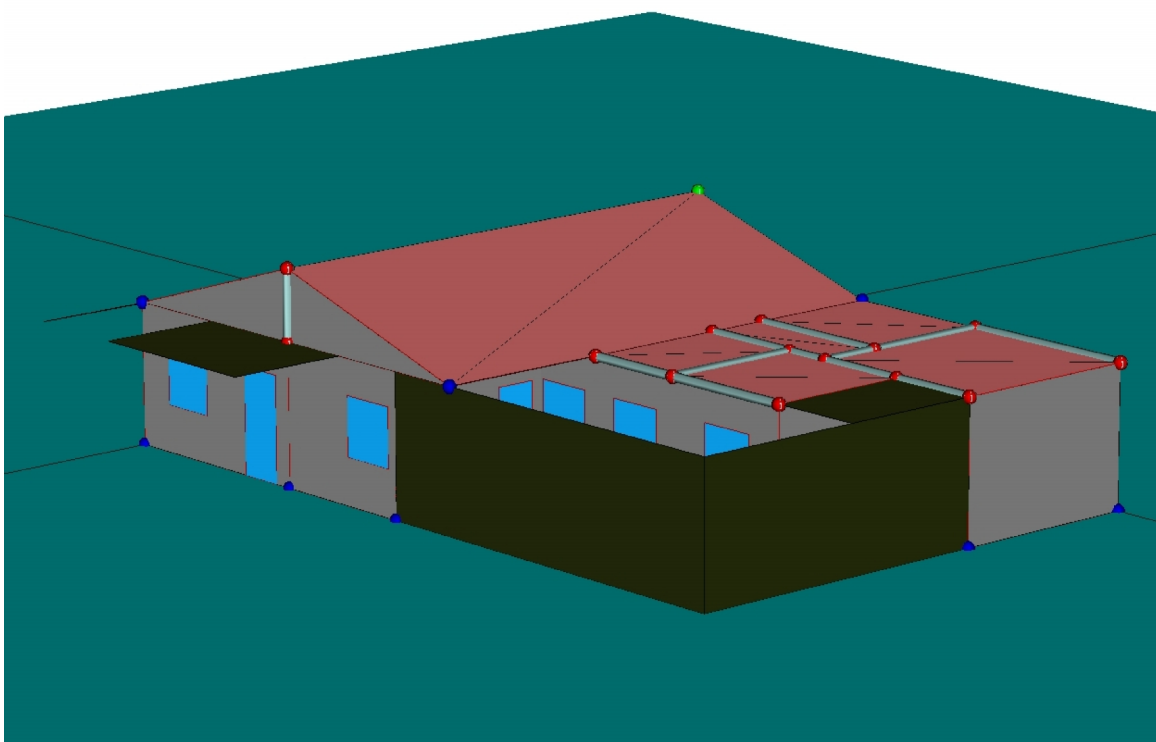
Fachada Norte y Este de la vivienda ejemplo.
